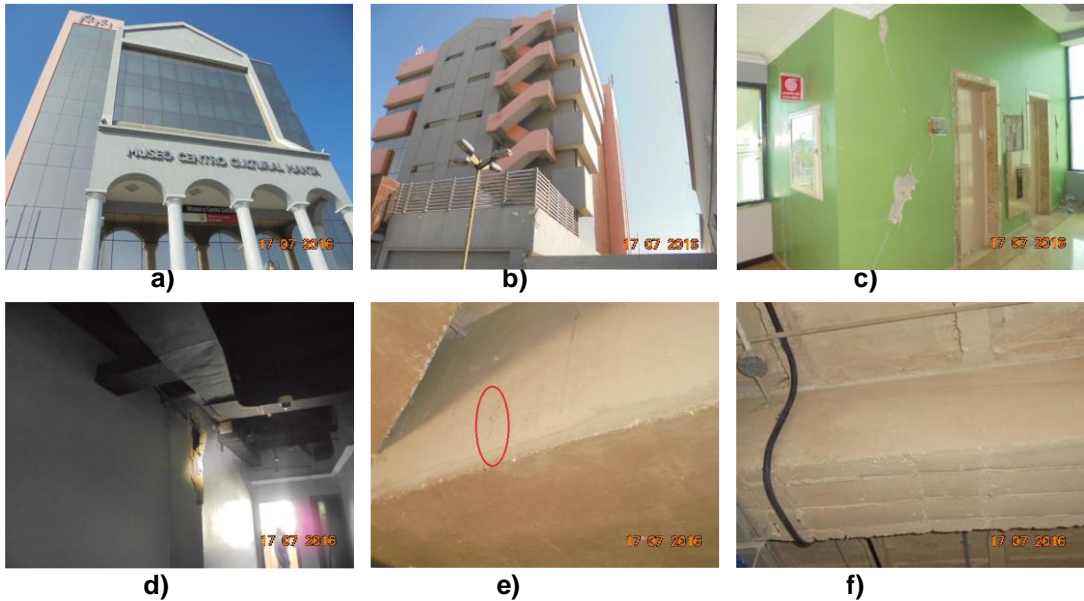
Museo Centro Cultural de Manta; a) Fachada Principal; b) Fachada Posterior; c) Daño en mampostería en el área del ascensor en el primer piso alto; d) Daño en intersección de mampostería; e) Vigas ortogonales en presencia de fisura en viga principal con peralte de 90 cm, en subsuelo; f) Viga Secundaria sin fisuras. Fuente: Aguiar *et al.* (2016,1)
